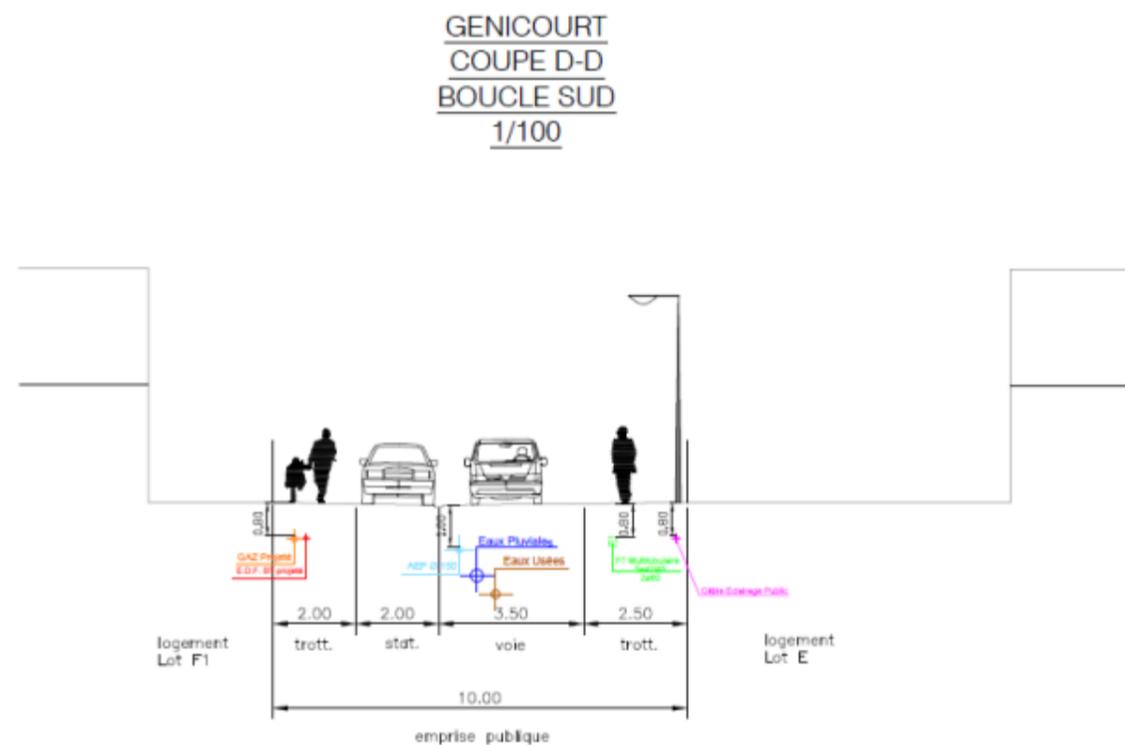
Coupe technique Bouche Sud (Est) – Génicourt
